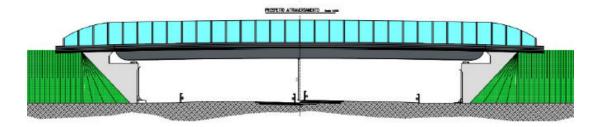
Prospetto nuovo sovrappasso (Fonte: Allegato 1 Tavola15)
